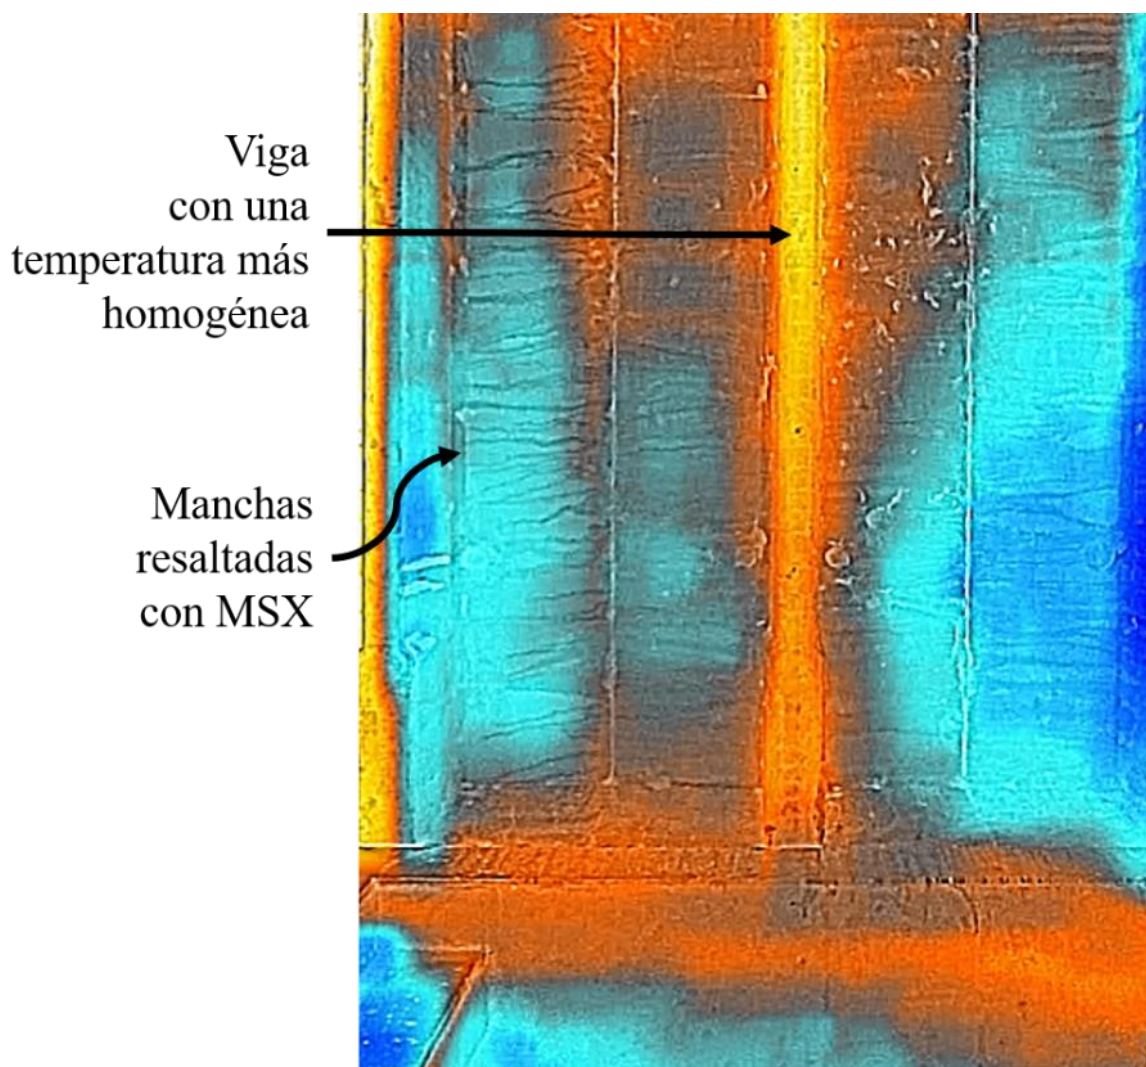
28 Ampliación de eflorescencias en vigas de la sección No. 8
